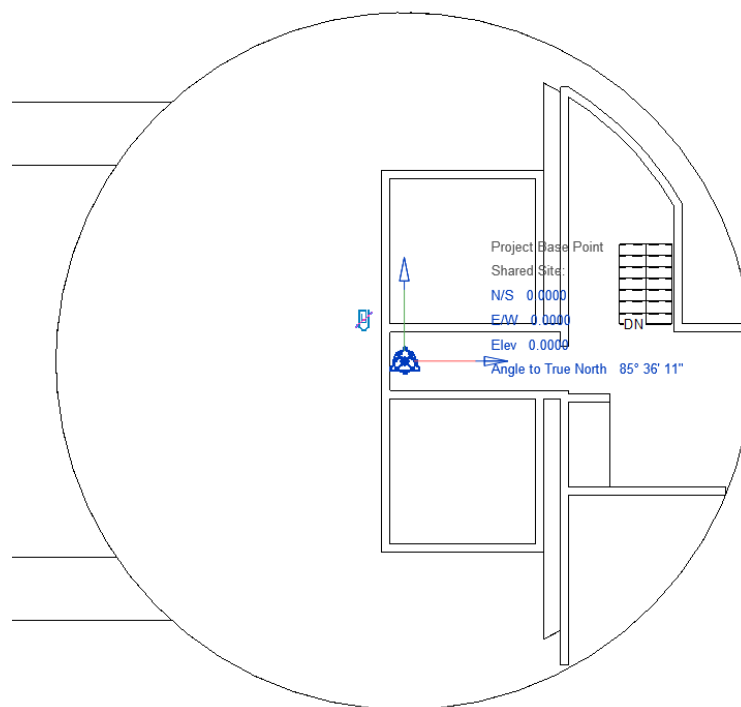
Vista em planta do poço no Revit com a configuração do Project Base Point
